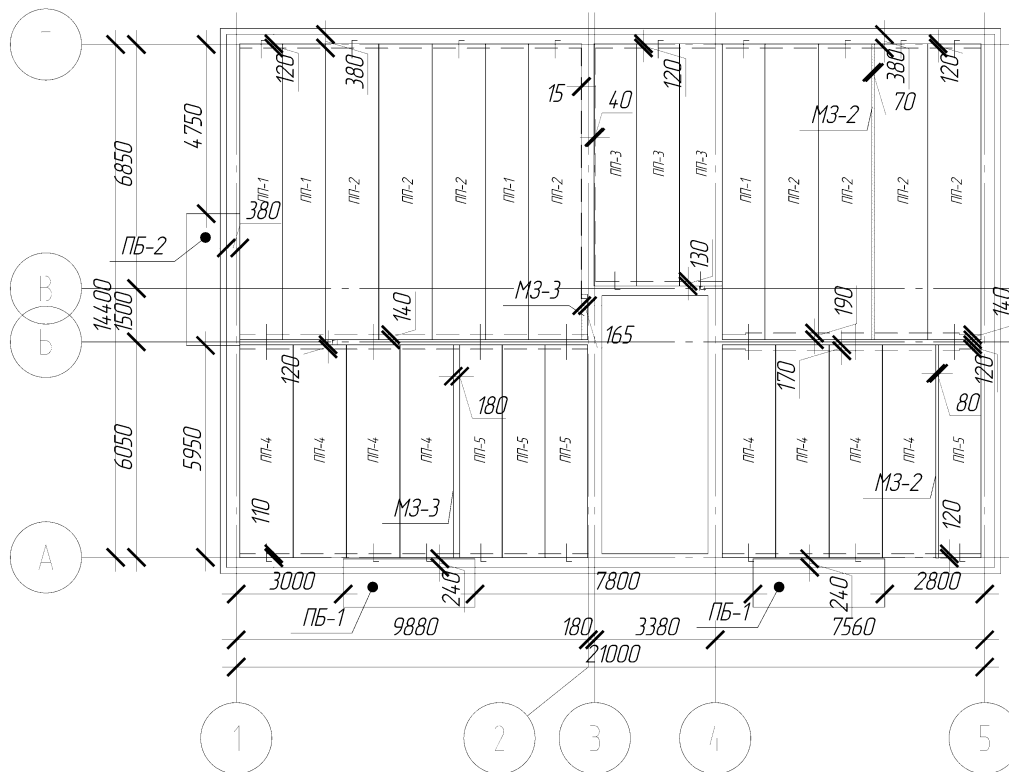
Схема расположения элементов перекрытия на отм. 0,000
